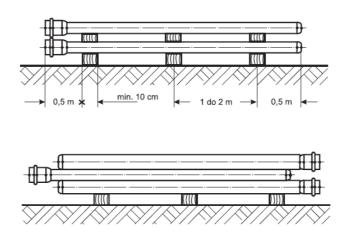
Складирование труб на строительном участке с прокладками и наперекрест
